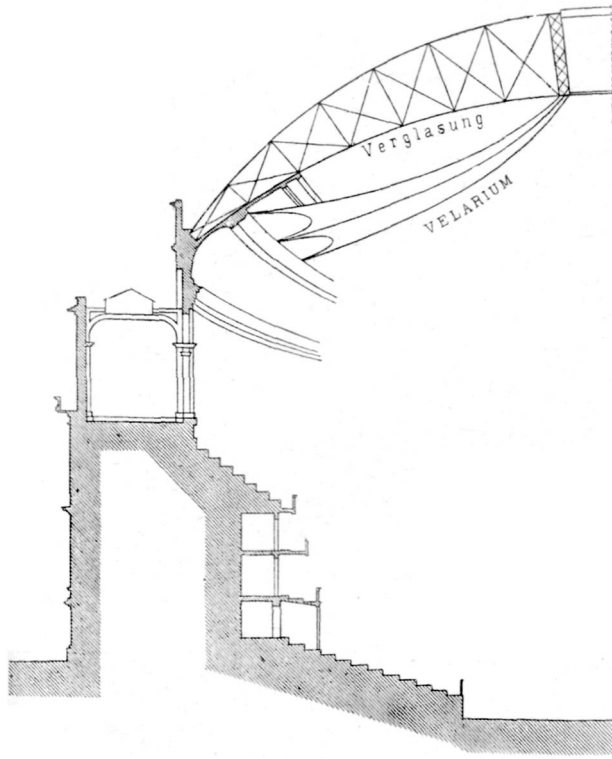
Albert Hall zu London. Schnitt¹⁾
